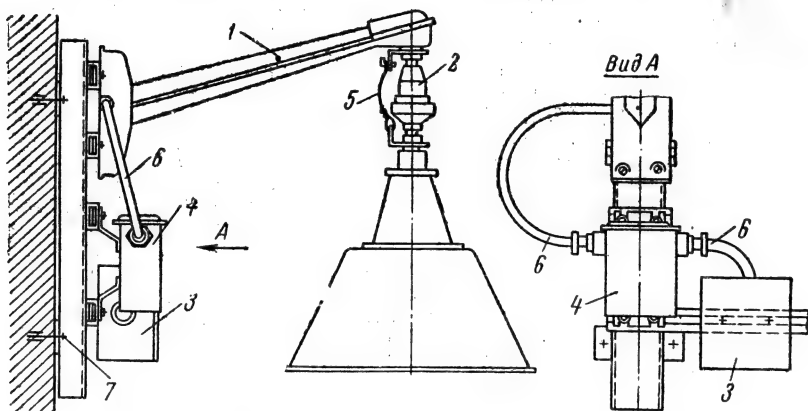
Установка светильника со штепсельным разъемом для ламп ДРЛ на кронштейне У114 на стене.
